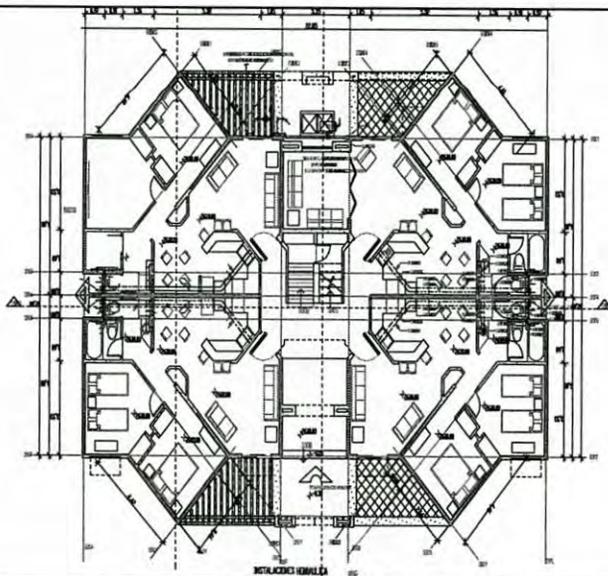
, Plano de planta arquitectónica planta baja de los departamentos.
